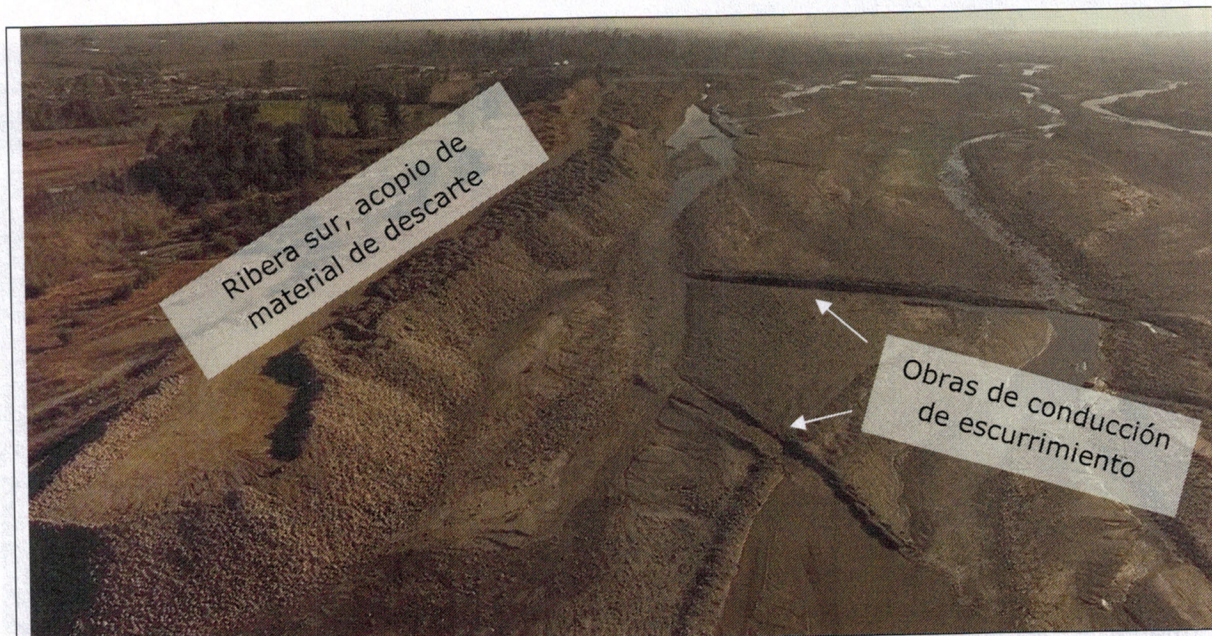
obras de conducción de escurrimiento hacia ribera sur
